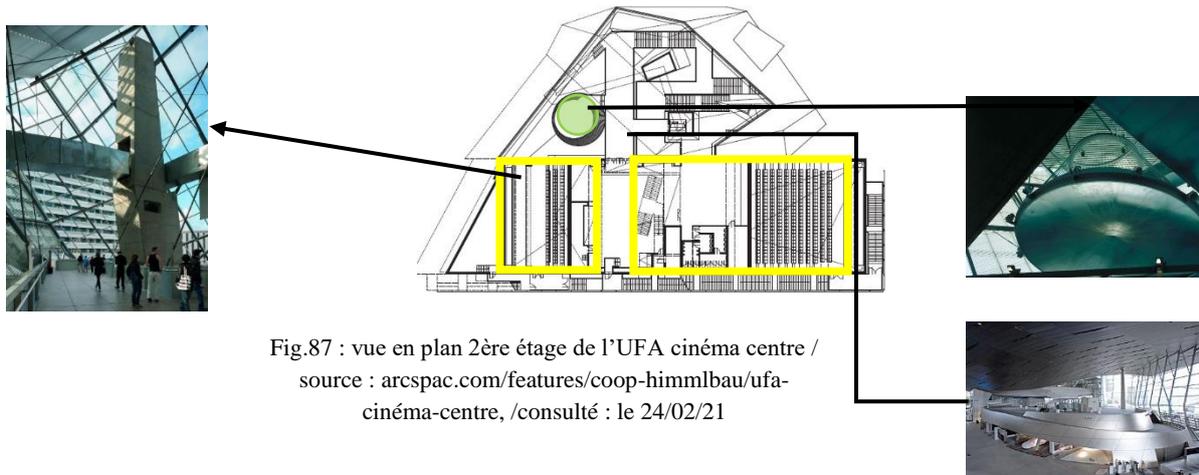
vue en plan 2ère étage de l'UFA cinéma centre /
